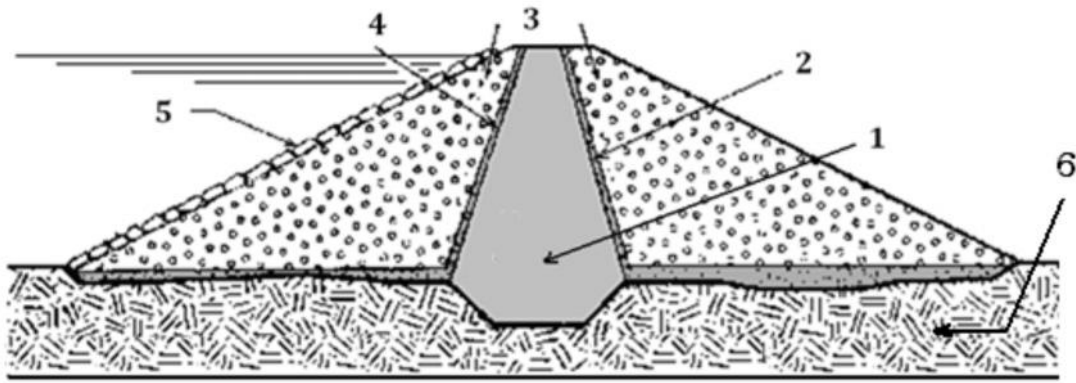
Coupe transversale d'une digue à zone (à zones)
